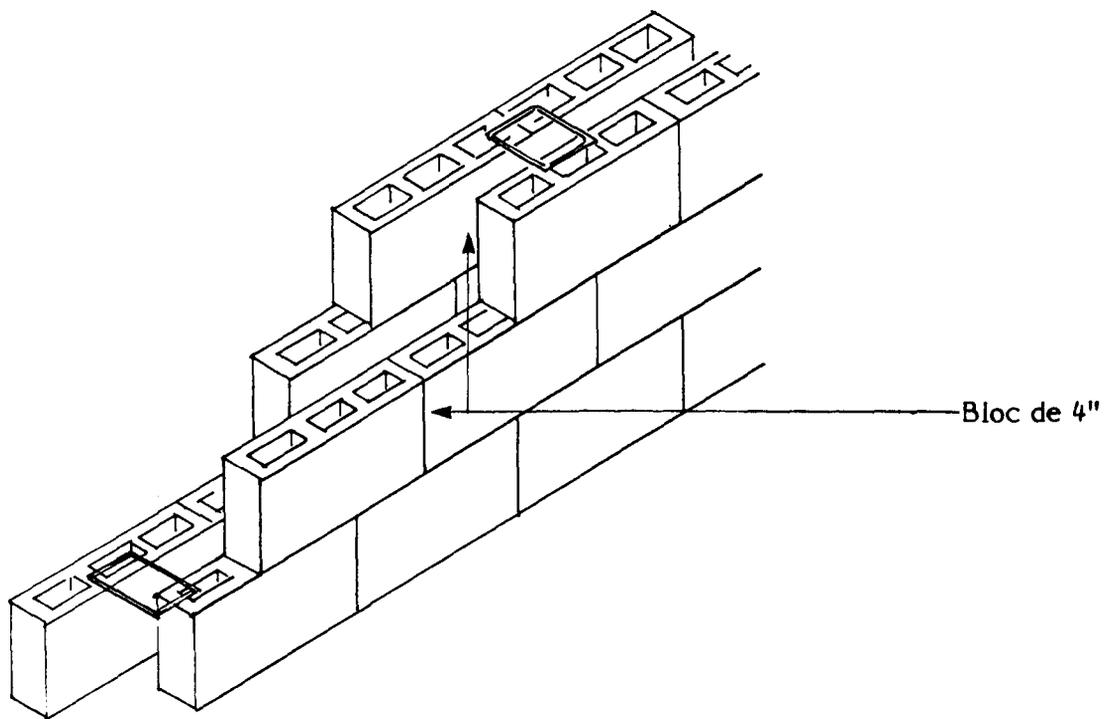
CONSTRUCTION D'UN MUR À CAVITÉS EN BRIQUES
